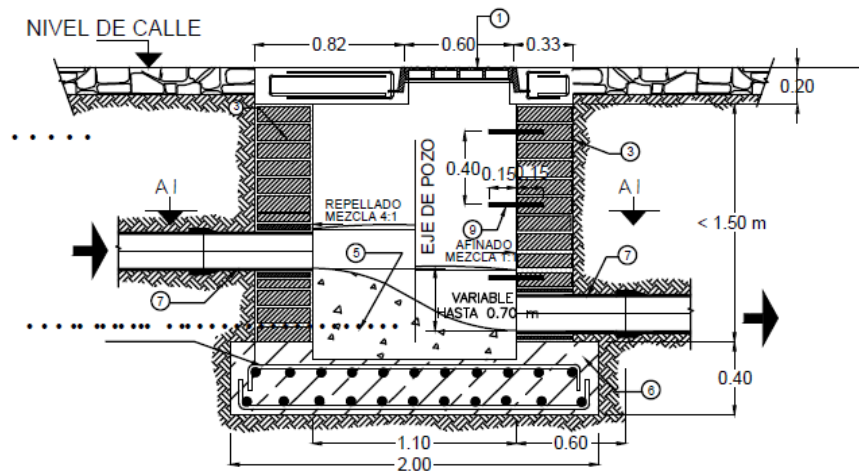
Detalle de caja de registro de mampostería [Fuente: Plano tipo de ANDA].
